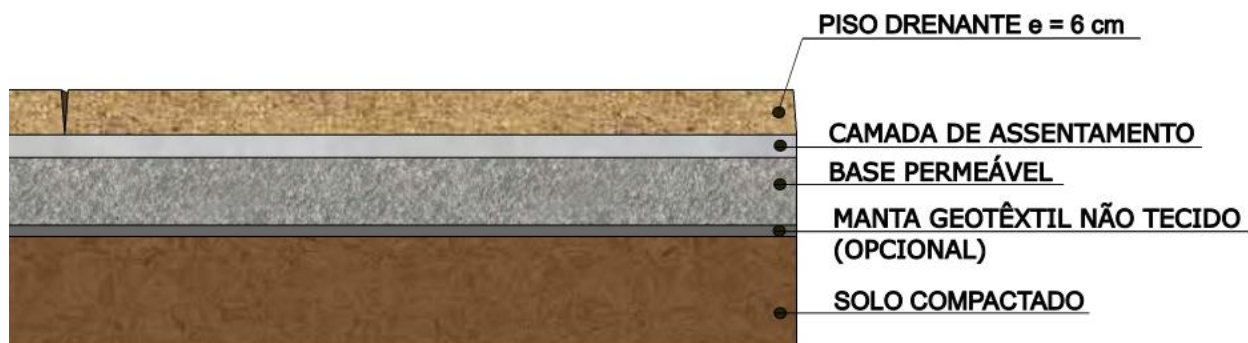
Passeio em piso drenante. Fonte: Elaboração própria.
